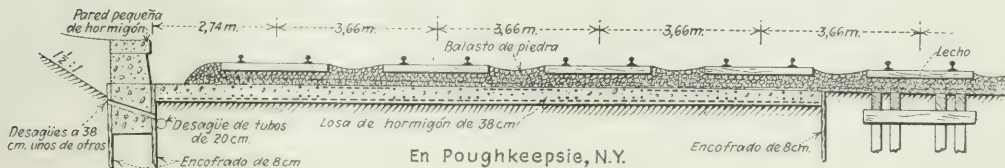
LOSA DE HORMIGÓN EN TERRENOS DE POCA CONSISTENCIA
